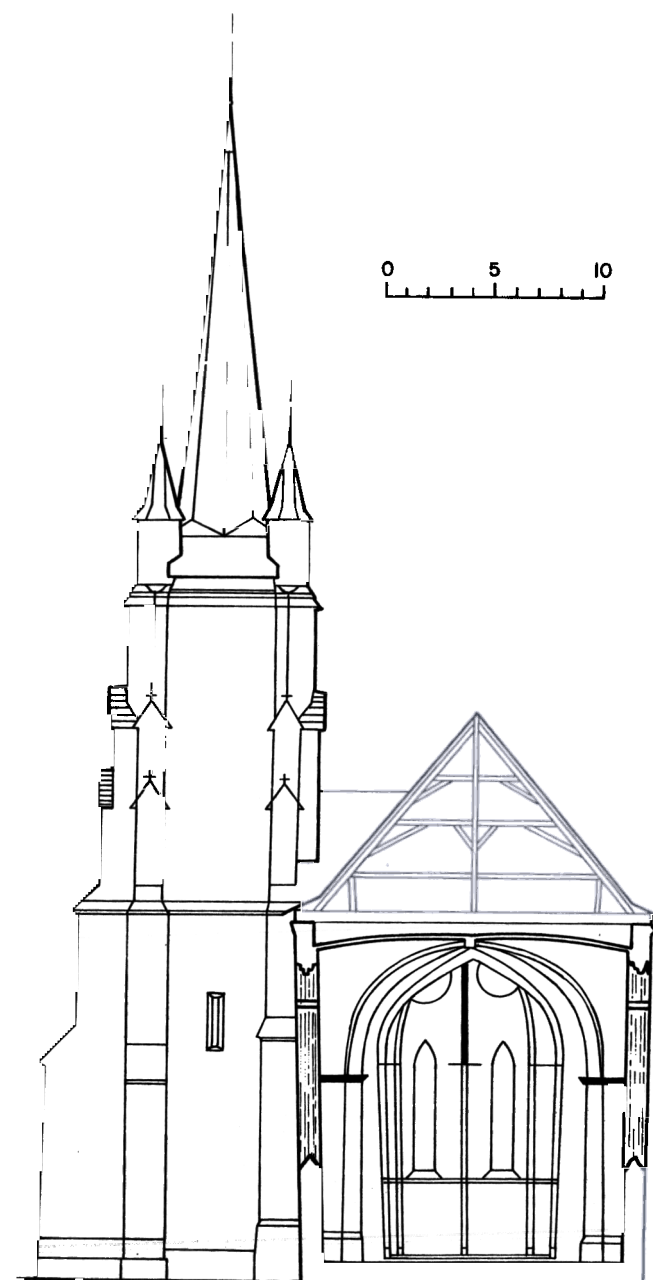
Profil en travers de l'église. Remarquer surtout le faux-aplomb de la façade nord de la nef.
